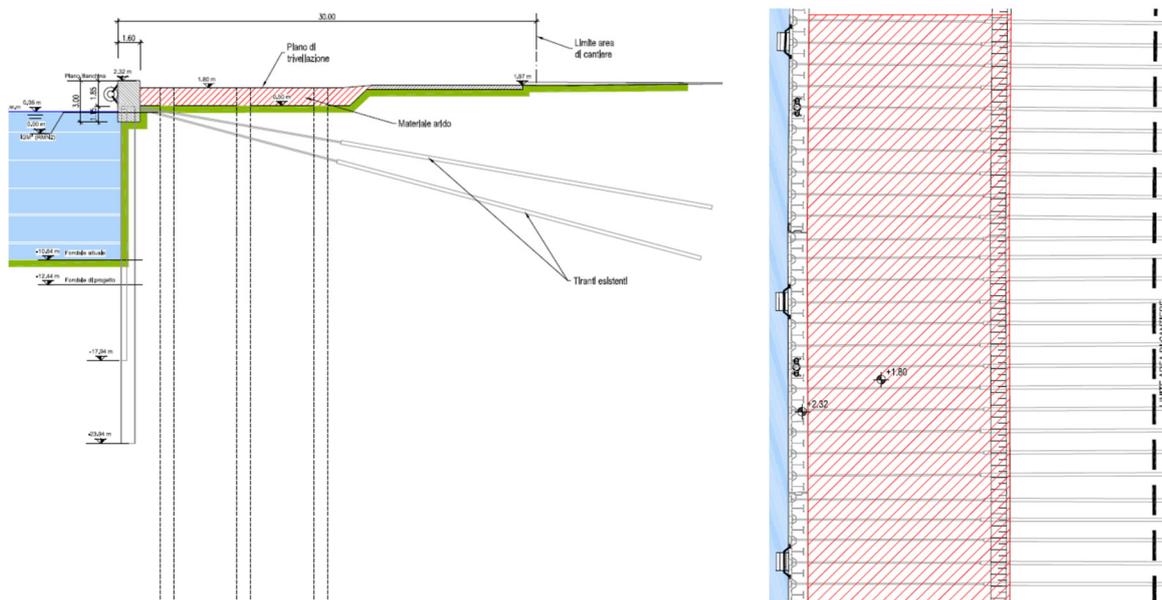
Banchina Trattaroli Nord – Fase 3 – Sezione e planimetria
